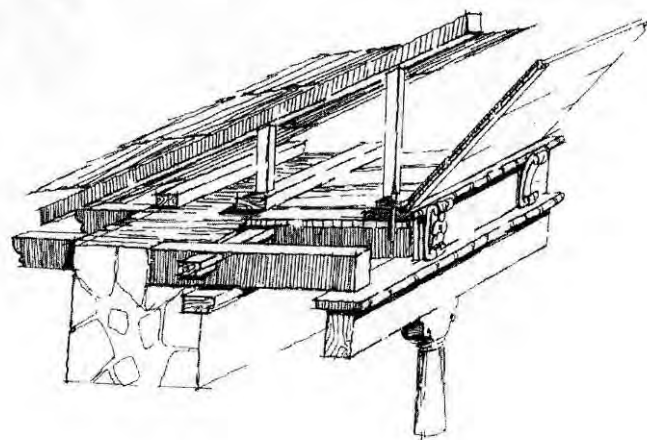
Detalle del artesón y la armadura*, Capilla de Santa Rosa, Michoacán.¹⁰³⁵ La armadura está construida por separado del artesonado y éste se encuentra hacia el interior del templo.
